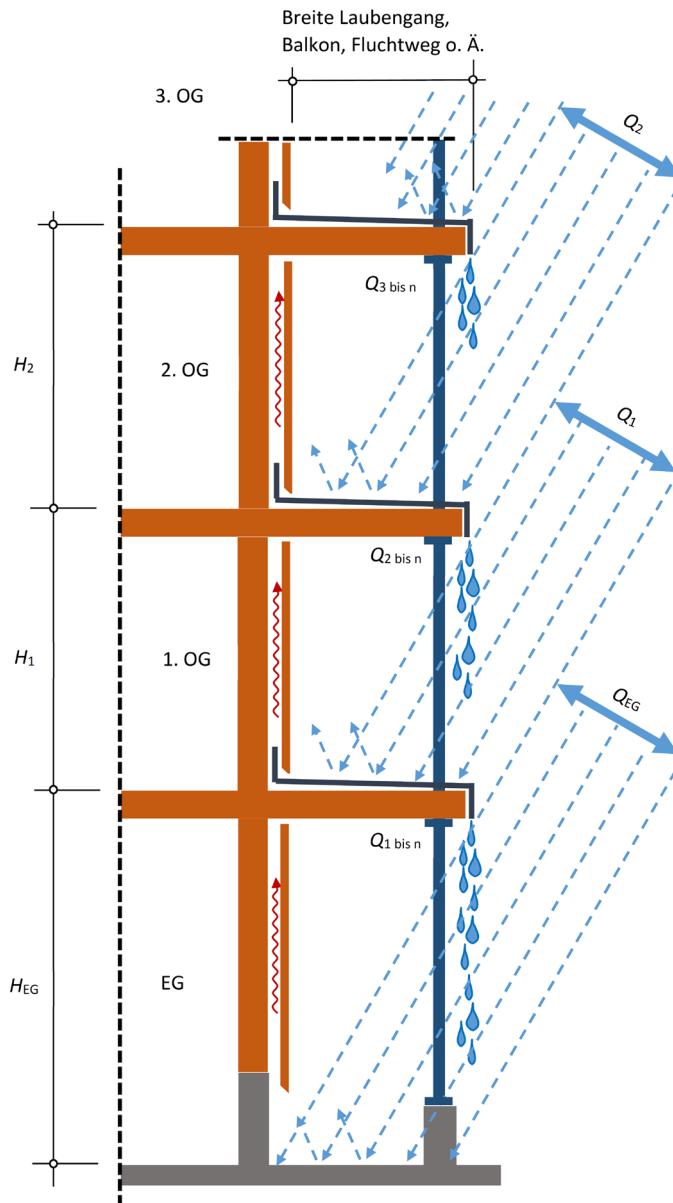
Laubengänge, Balkone o. ä. zum Schutz von Fassadenelementen
